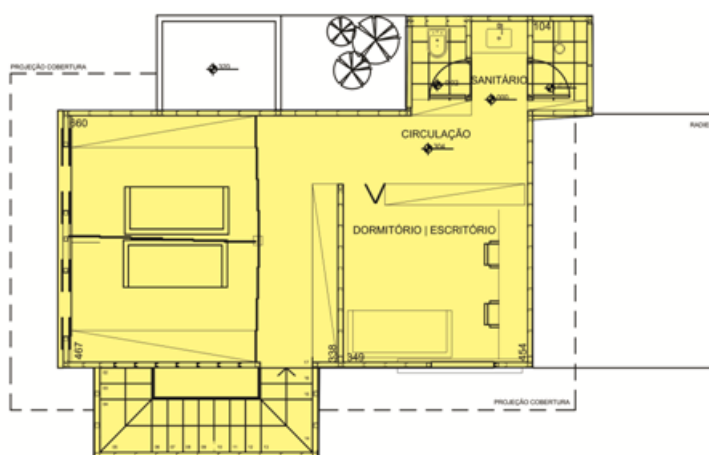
Planta do pavimento superior da expansão vertical da unidade MORA[1], com 98m².
